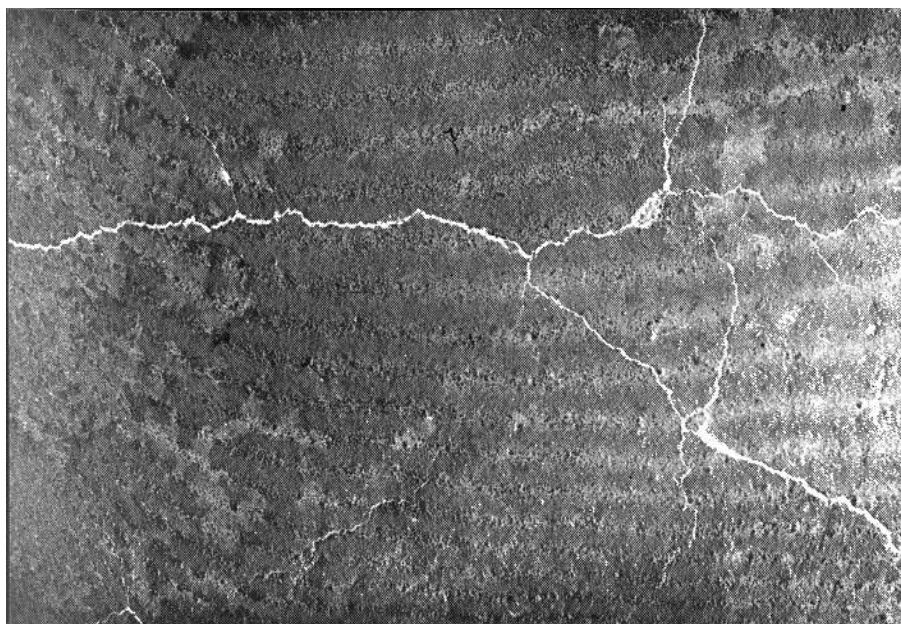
Fissuration d'une dalle (Venuat 1992).
